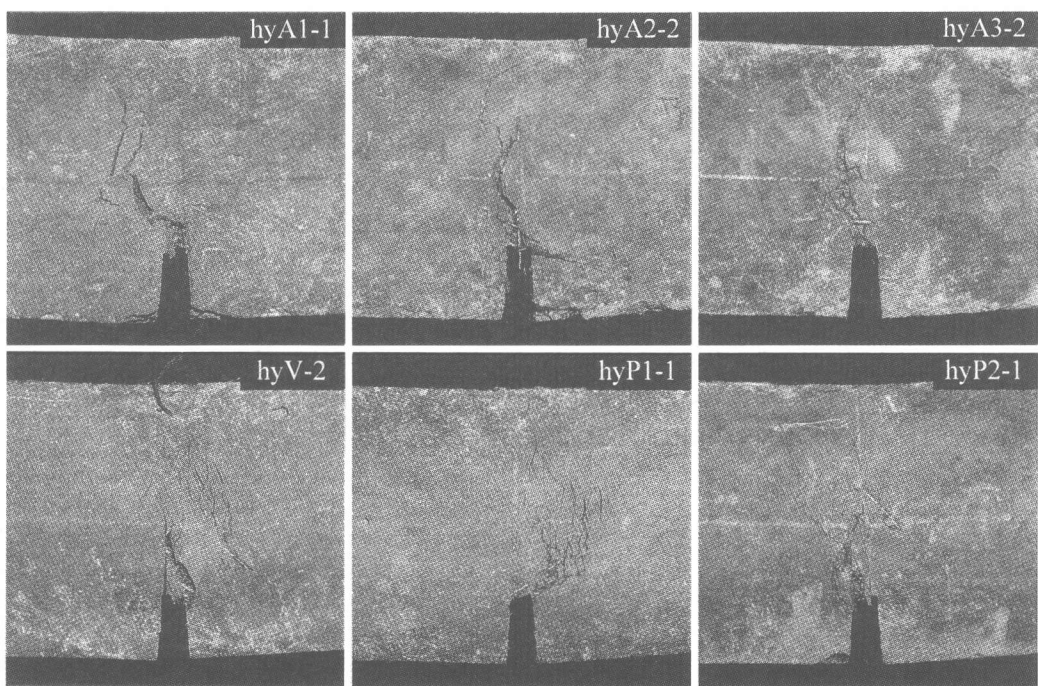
各シリーズの切り欠き先端のひび割れ状況
